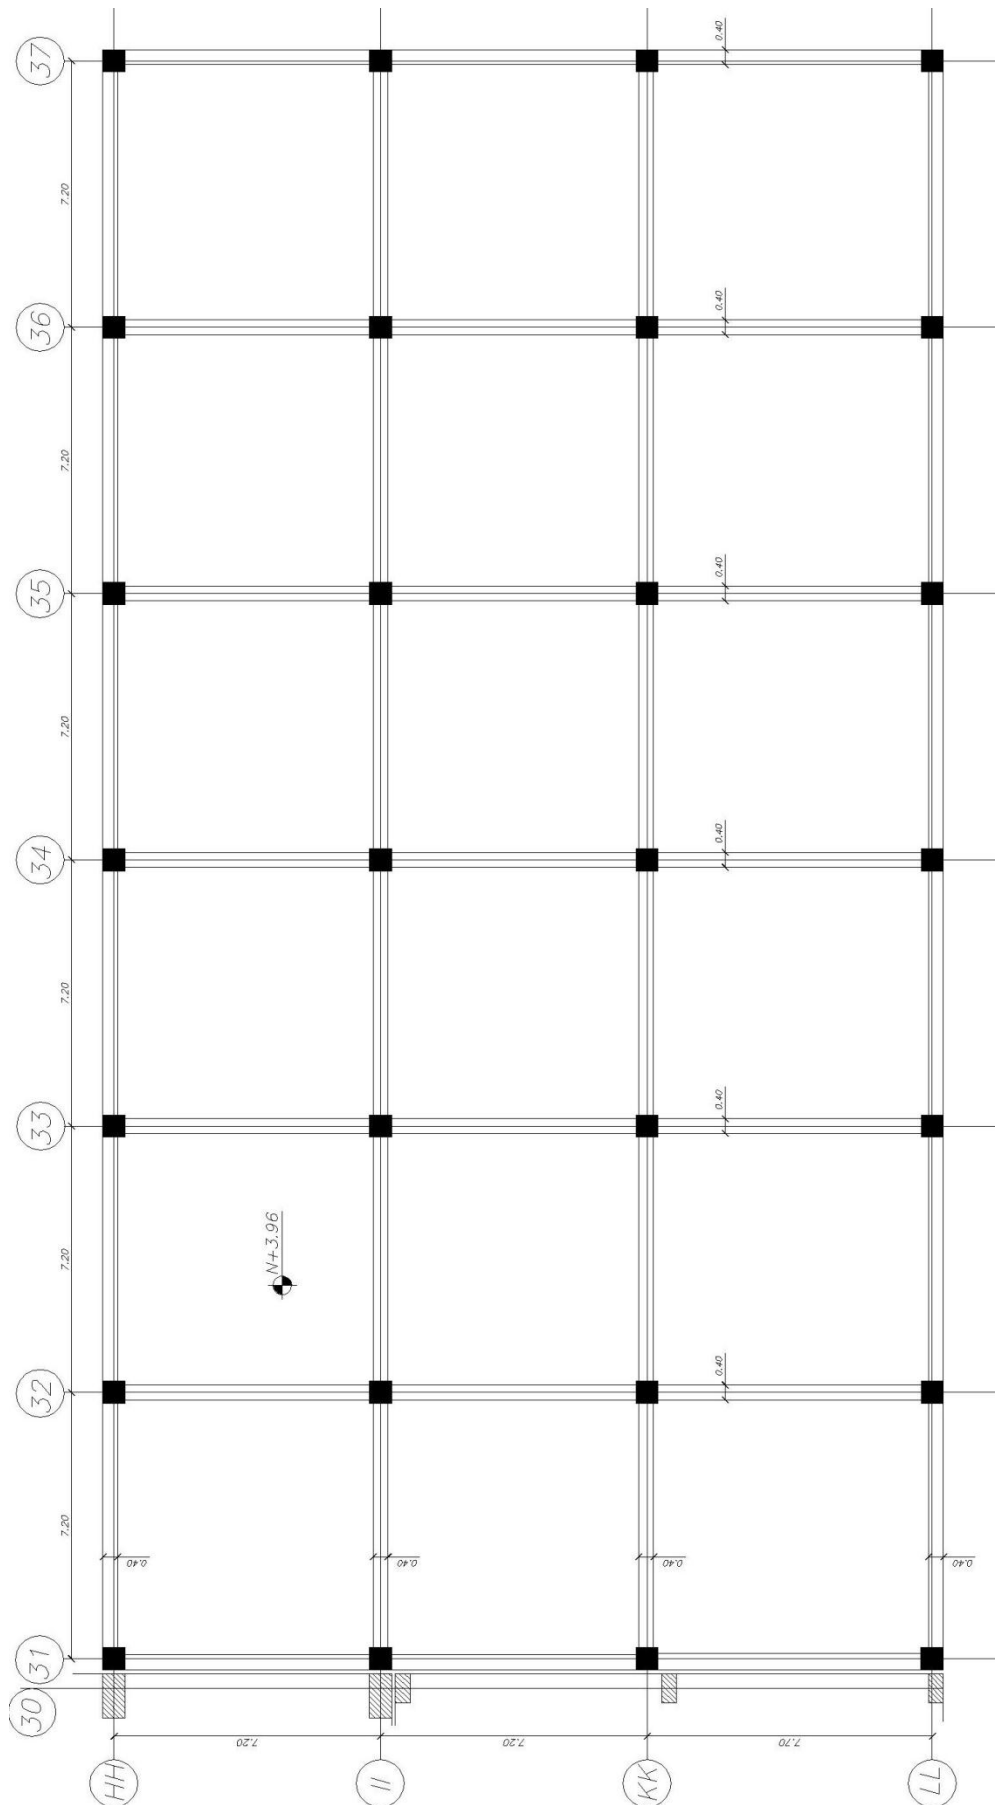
PLANTA ESTRUCTURAL NIVEL: +3,96 m C. QUIRURGICO
